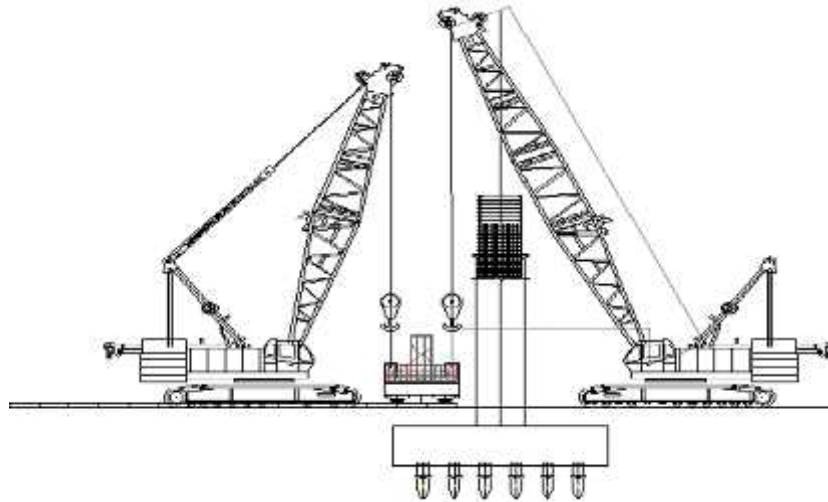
Cor Pier Head Cast in situ Tahap 1(foto lapangan)
